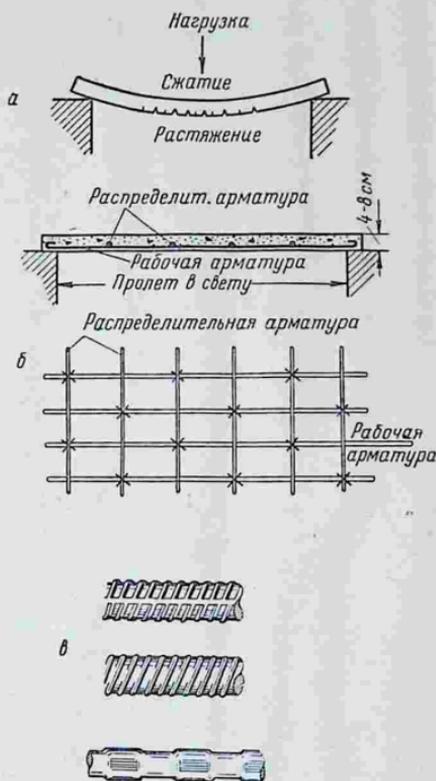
Арматура: а—схема работы плиты на изгиб; б—конструкция железобетонной плиты и деталь арматуры; в—арматура периодического профиля, горячекатанная и холодноуплощенная.
